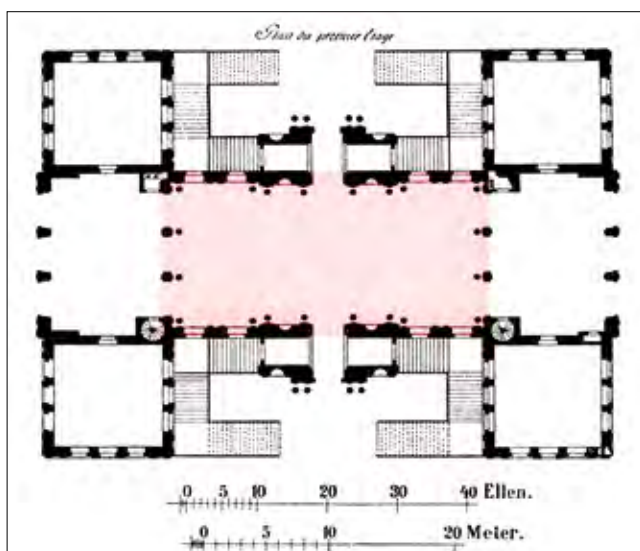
Dresden, Palais im Großen Garten, Grundriss 1. Obergeschoss (nach C. Gurlitt; Festsaal rot gekennzeichnet)
